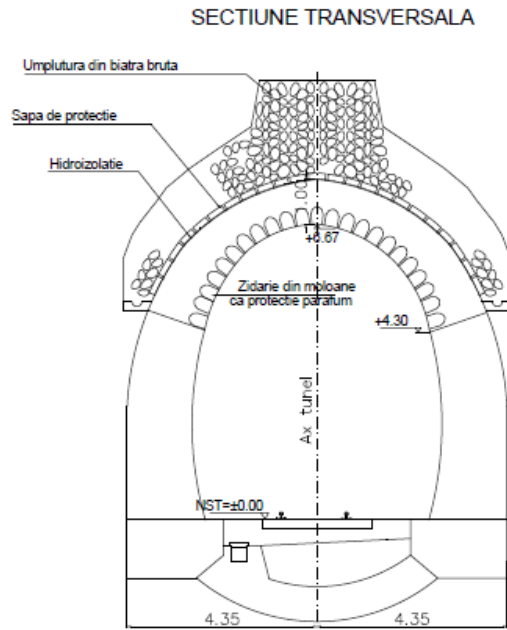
Secțiunea tip potcoavă
